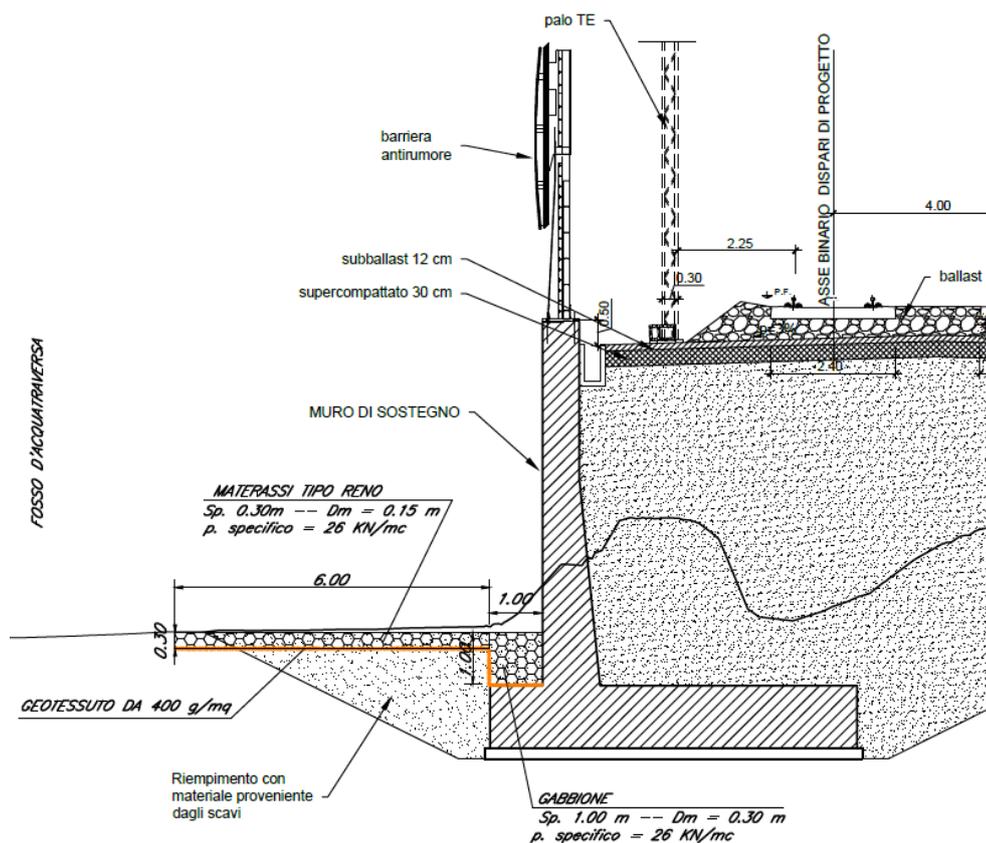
Fosso d'Acquatraversa: sezione "tipo" delle opere di protezione del rilevato.
